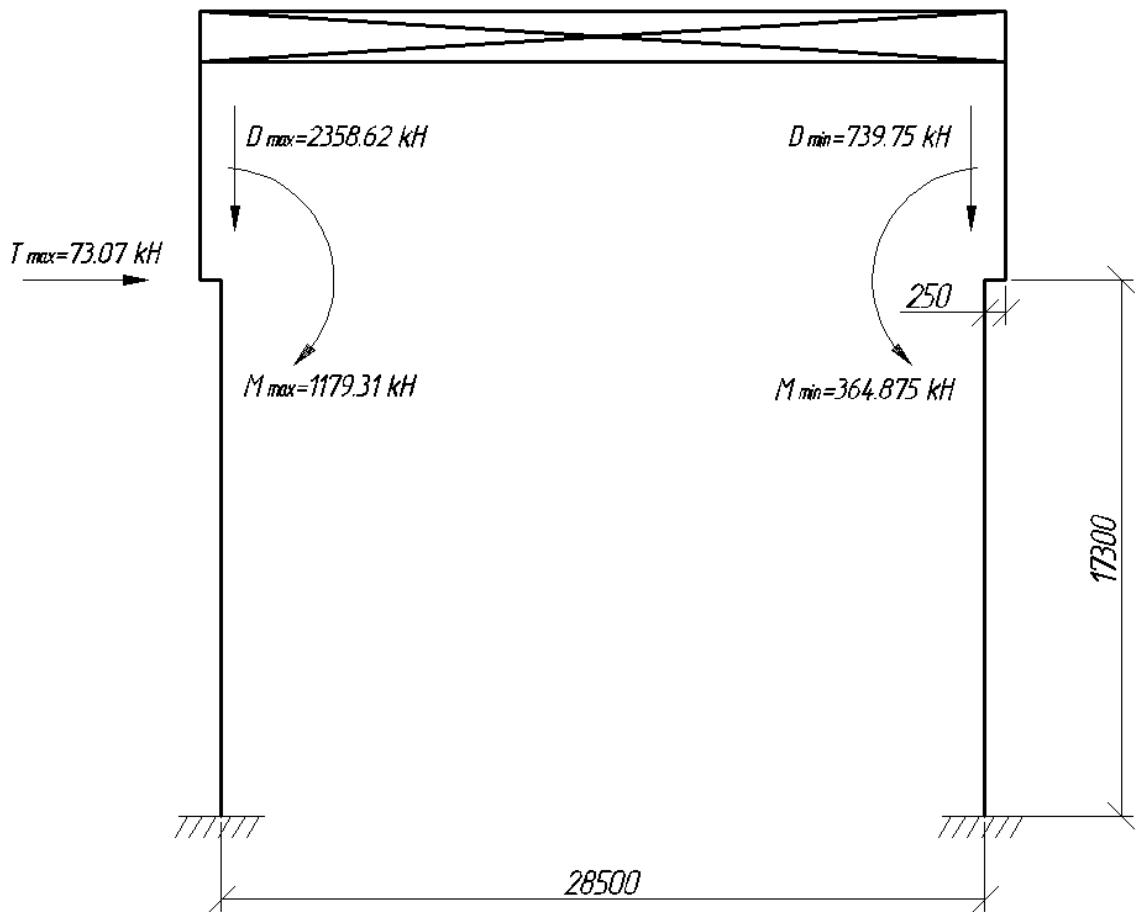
Розрахункова схема рами на дію кранових навантажень.
